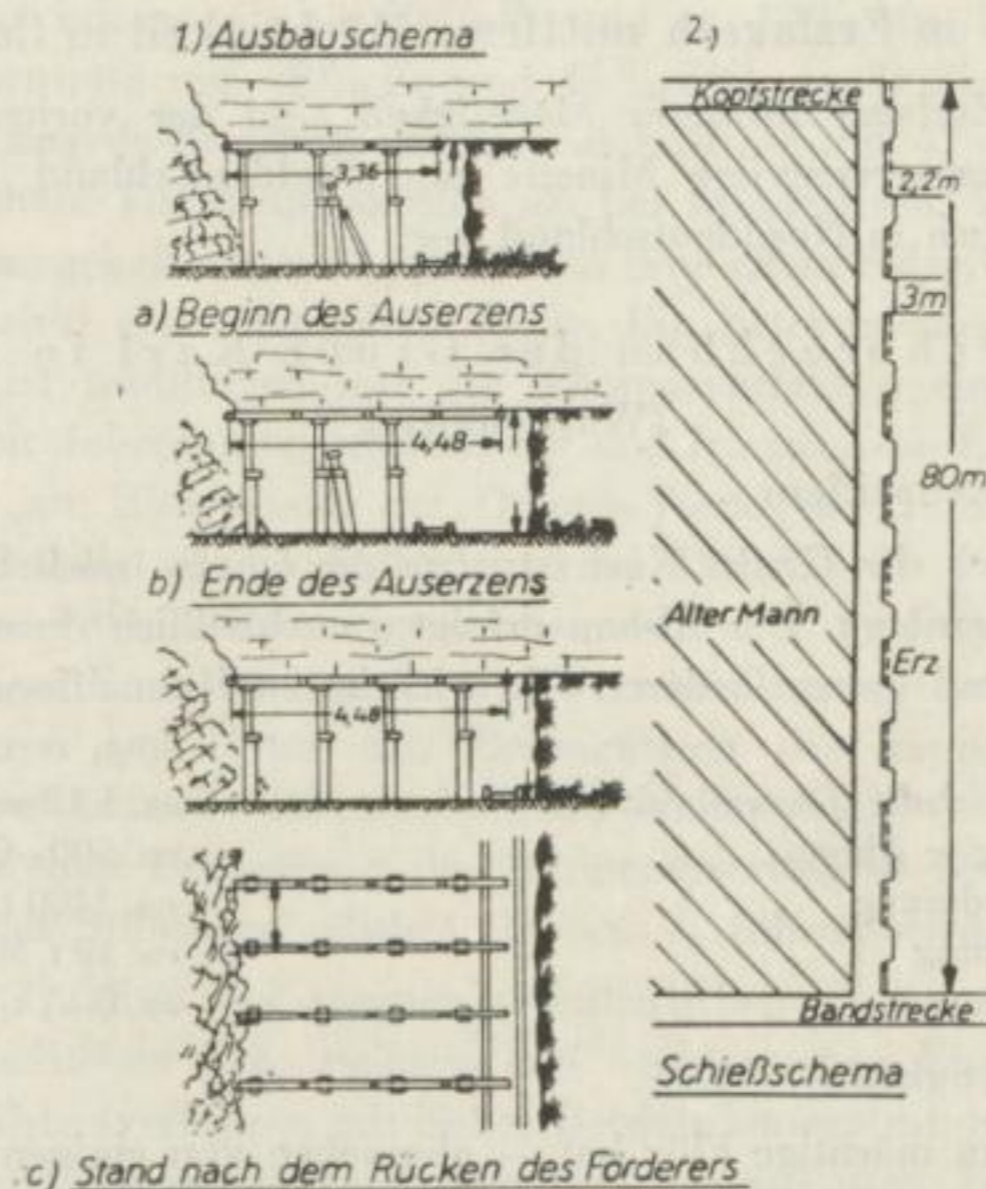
Grundriß und Ausbauschema des Strebbruchbaues, Grube Karl in Geislingen
